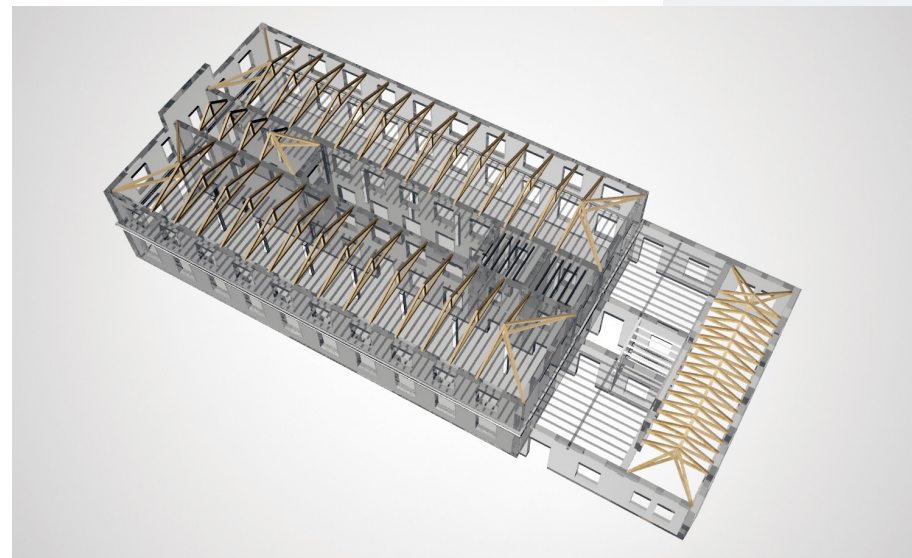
, Estructura Intervención 1970 Planta Alta. Nuevos pilares en planta baja, correa perimetral de atado y nuevo forjado en patio.
